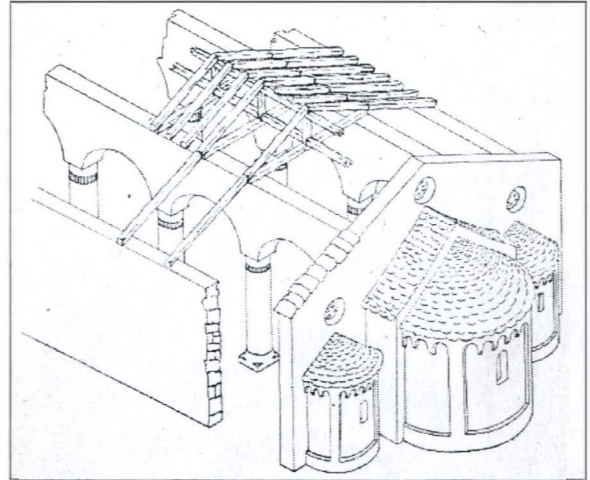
Cubierta de madera según Puig i Cadafalch
